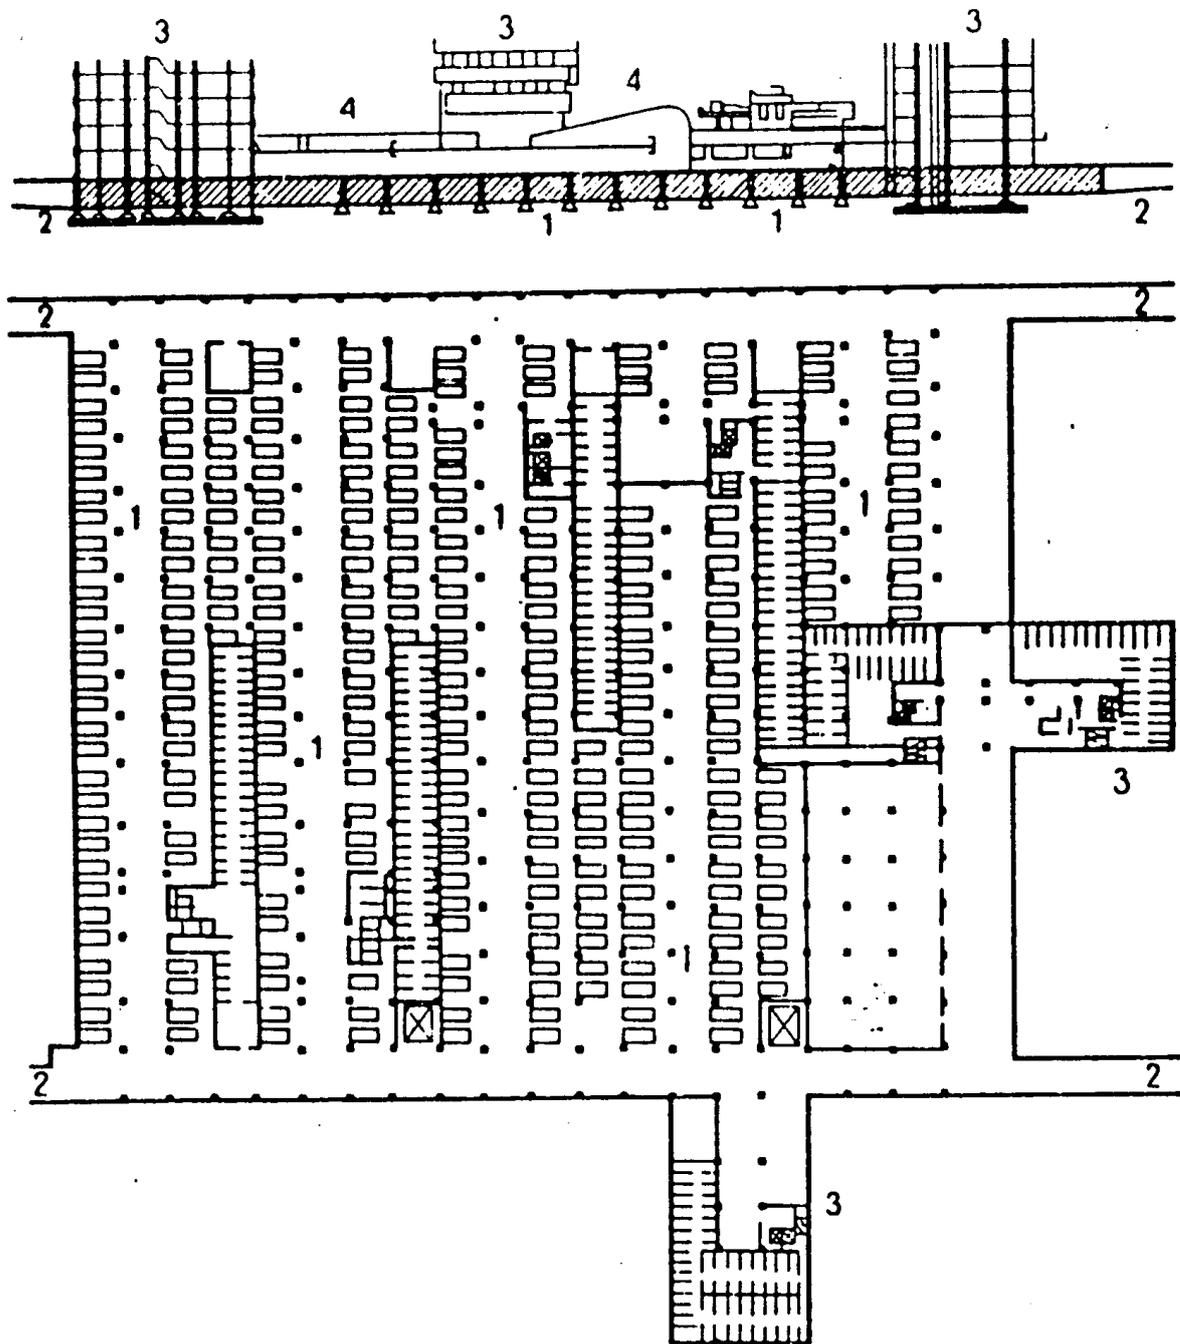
Разрез и план подземного гаража на 300 машино-мест, расположенного под четырьмя многоэтажными жилыми домами и центром обслуживания. Микрорайон "Лебедь" в Москве. Моспроект-1, арх. А.Д.Мейерсон и др. Продольный разрез и схема плана гаража:
